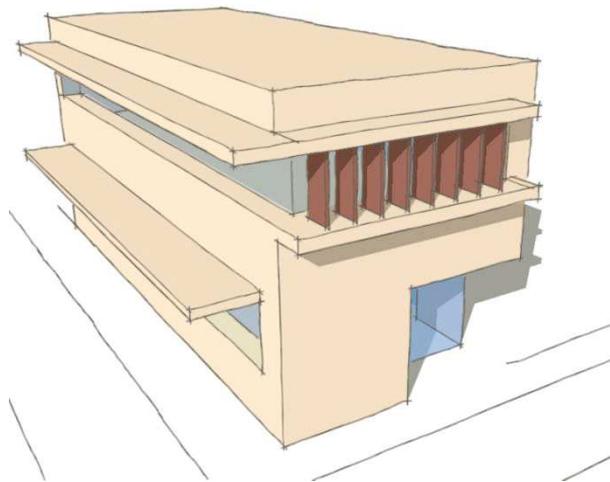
Parasoles verticales sobre fachada Oeste.
